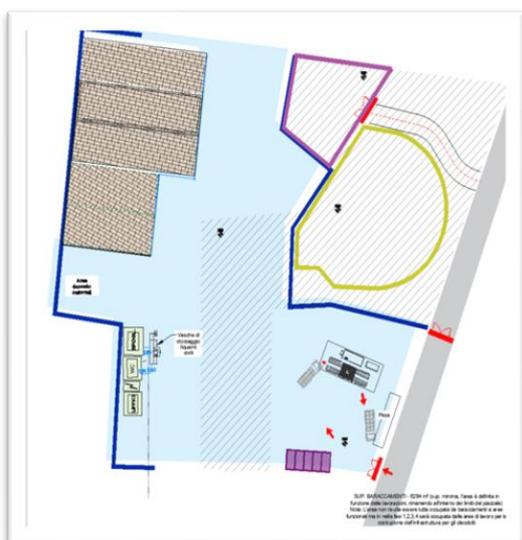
Area di cantiere C1 - Layout di cantiere ed inquadramento territoriale
